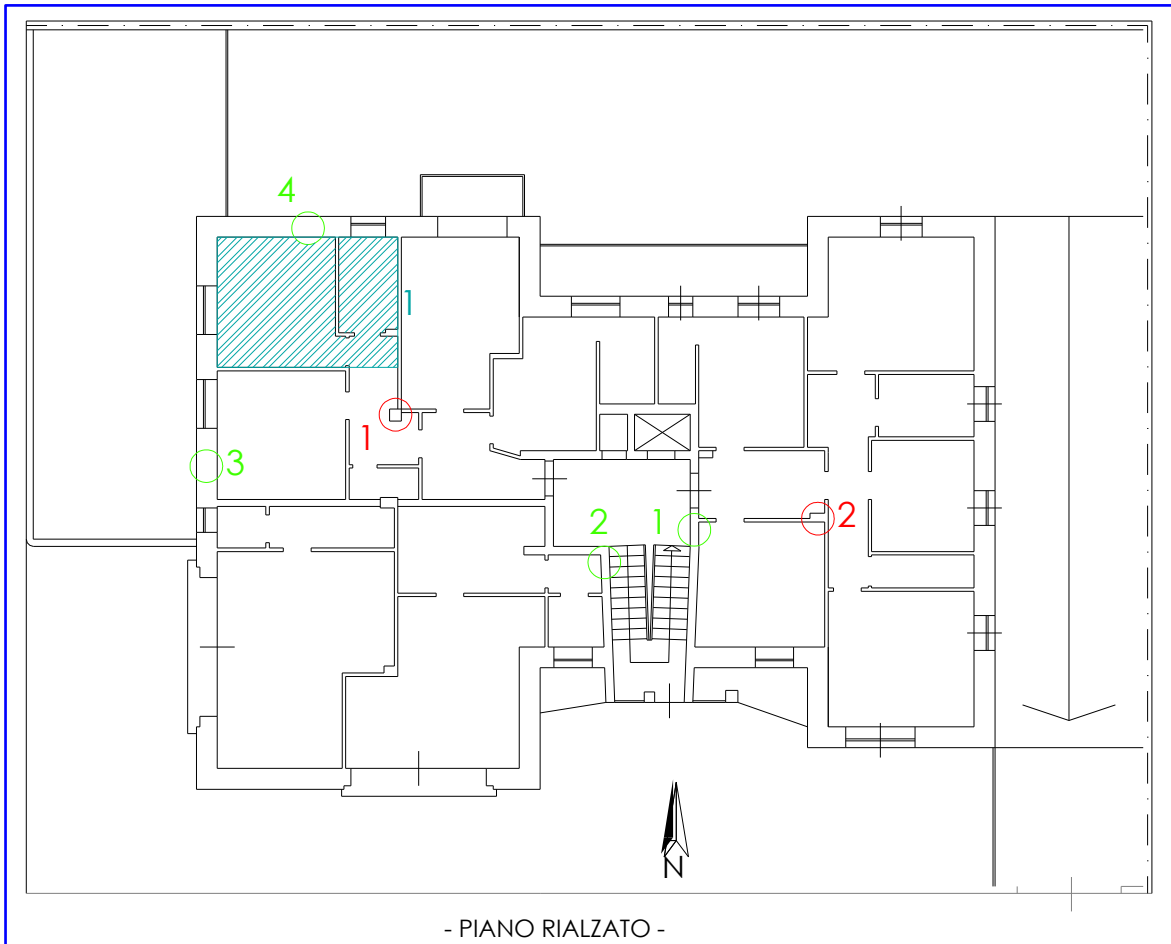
Planimetria del piano rialzato (L0) con l'ubicazione delle zone esaminate
